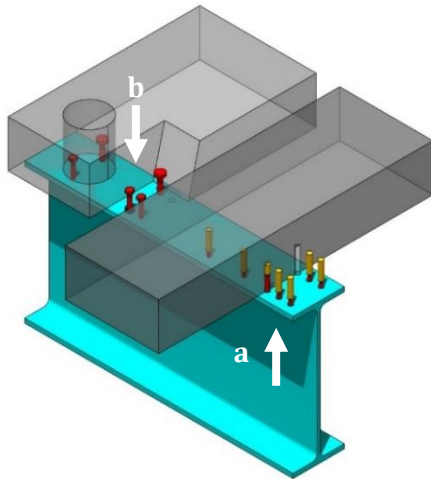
Conexión de tablero a viga metálica accediendo de paramento superior: anclaje post-instalado inferior (a) y por demolición de losa y conector soldado o roscado (b).
